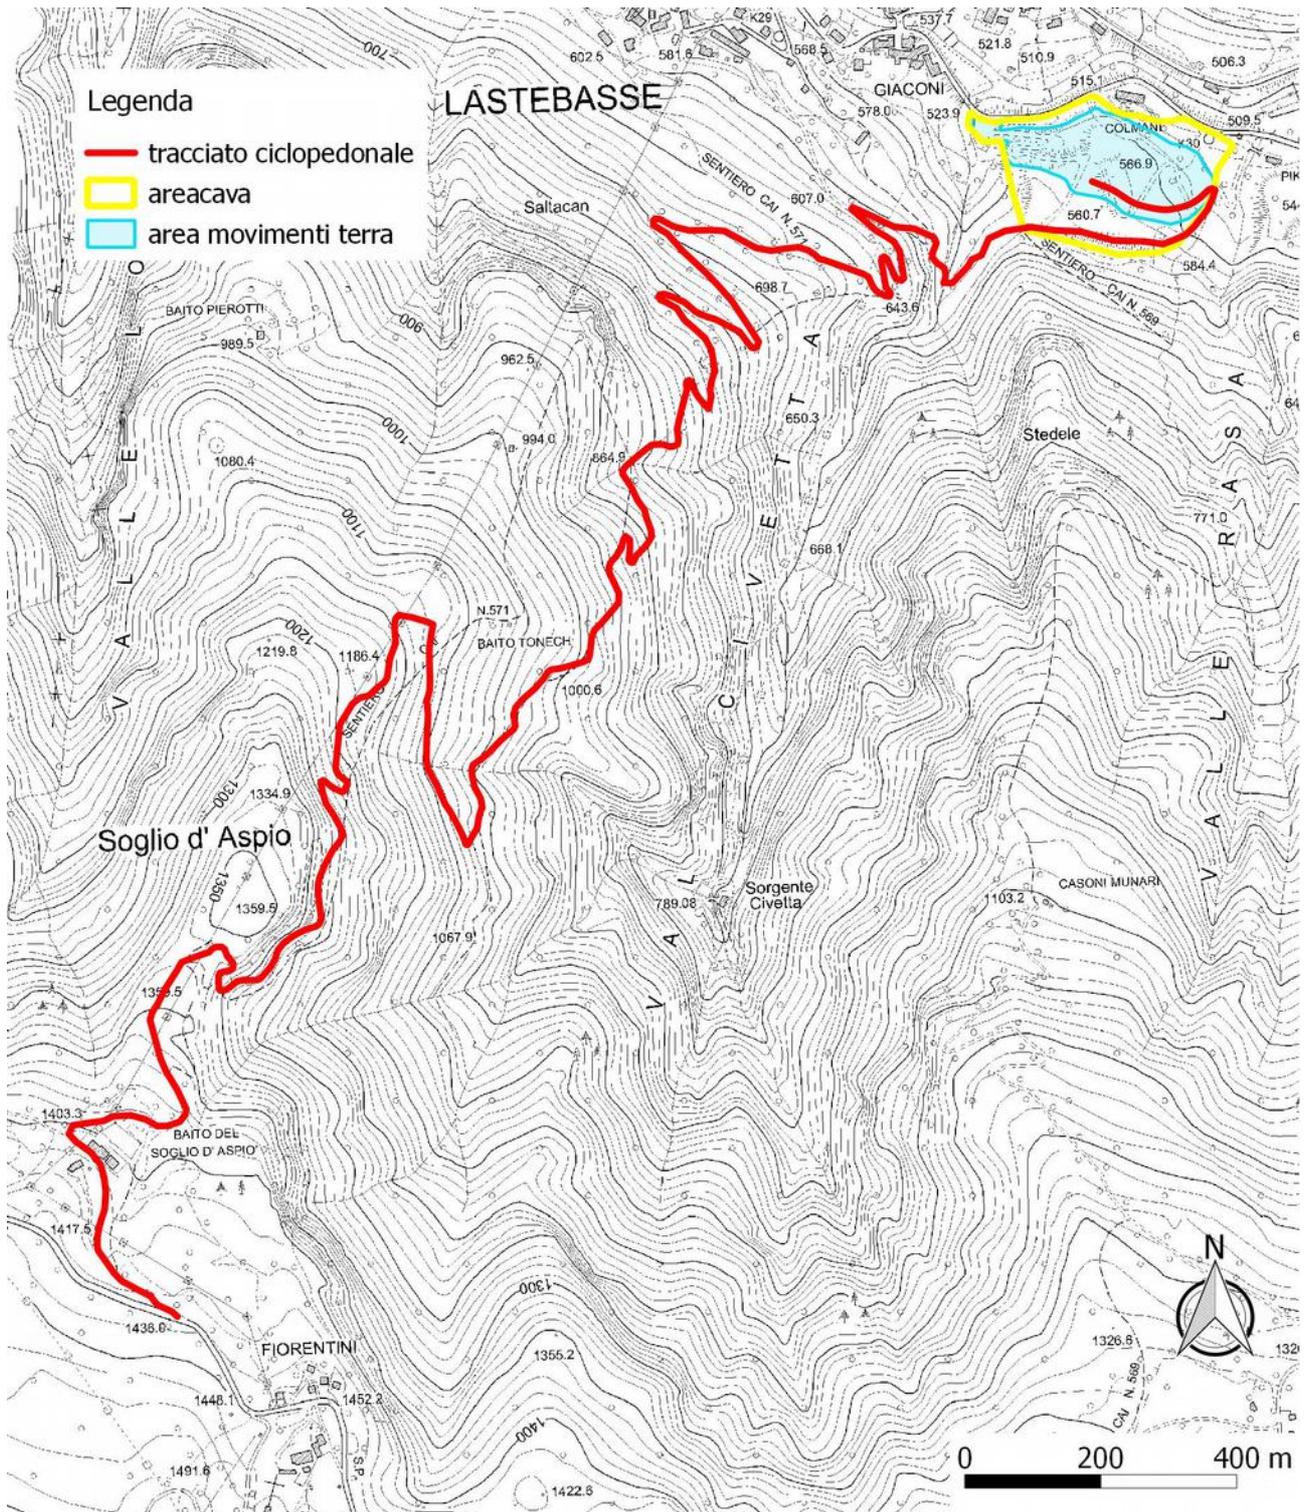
PLANIMETRIA DEL CANTIERE A SCALA 1:10.000
